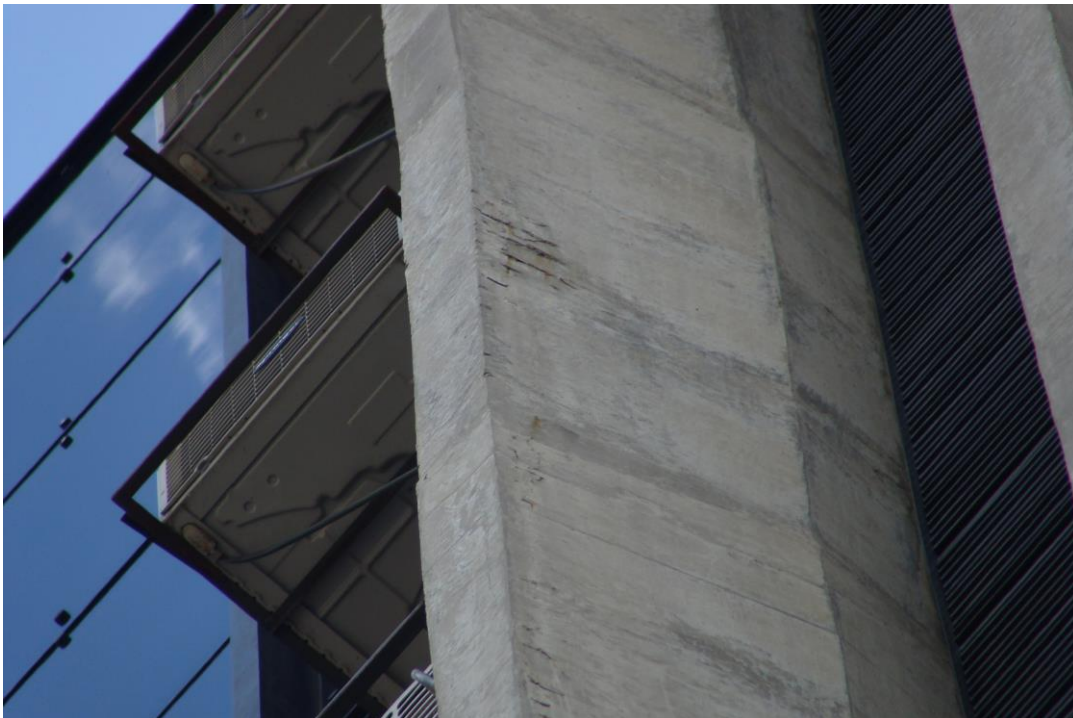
Armadura exposta pilar P12 (9º pavimento) (19/11/2013)
